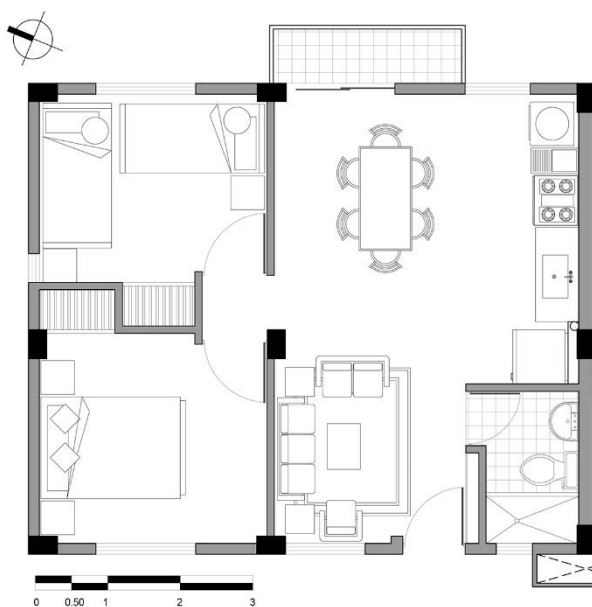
Planta arquitectónica departamento 50m2 Ciudad Bicentenario.
